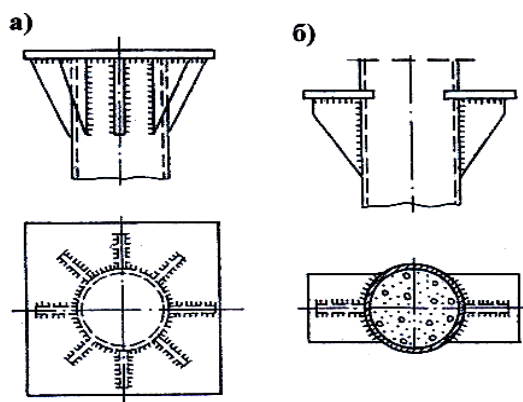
Конструкции оголовков центрально сжатых трубобетонных колонн: а – с опорным листом, б – с консолью [3]
